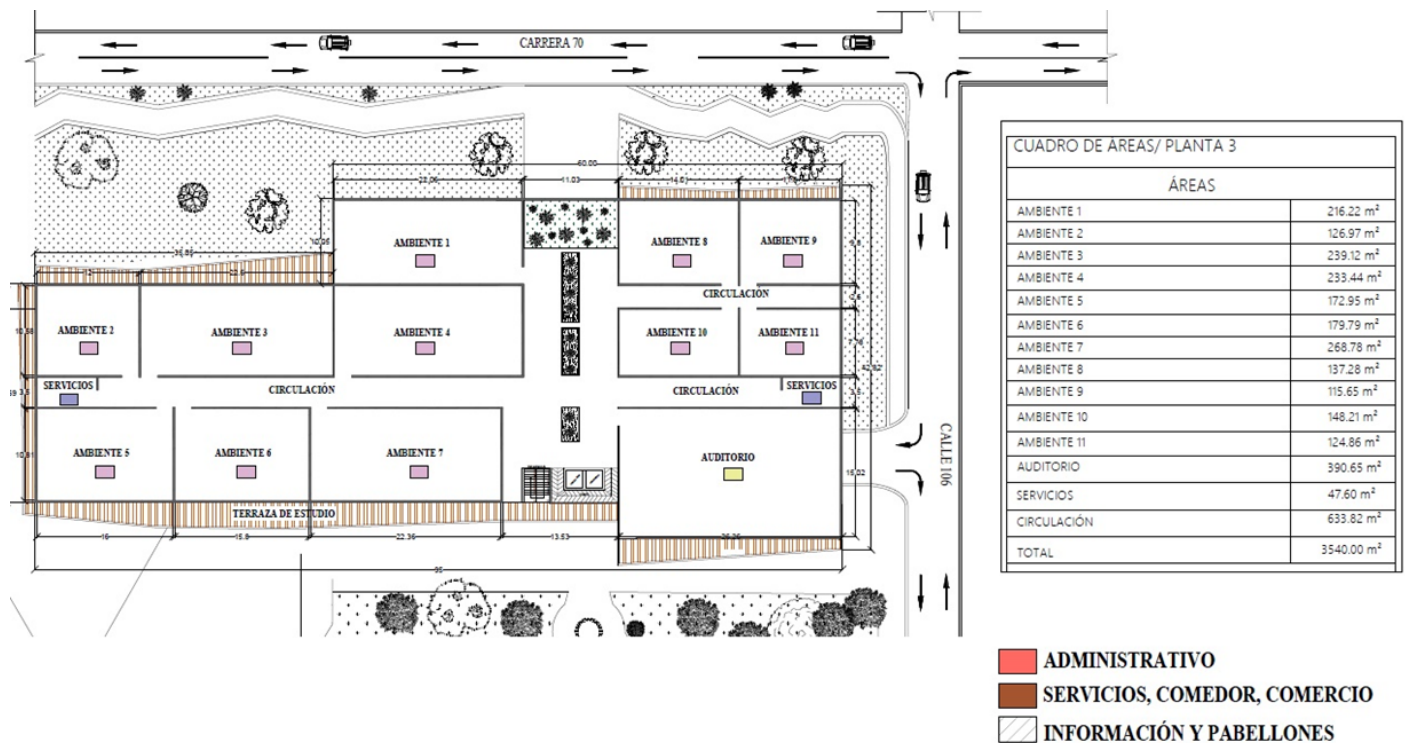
Diseño conceptual de la planta 3. Acá se encuentran 11 ambientes y un auditorio.
